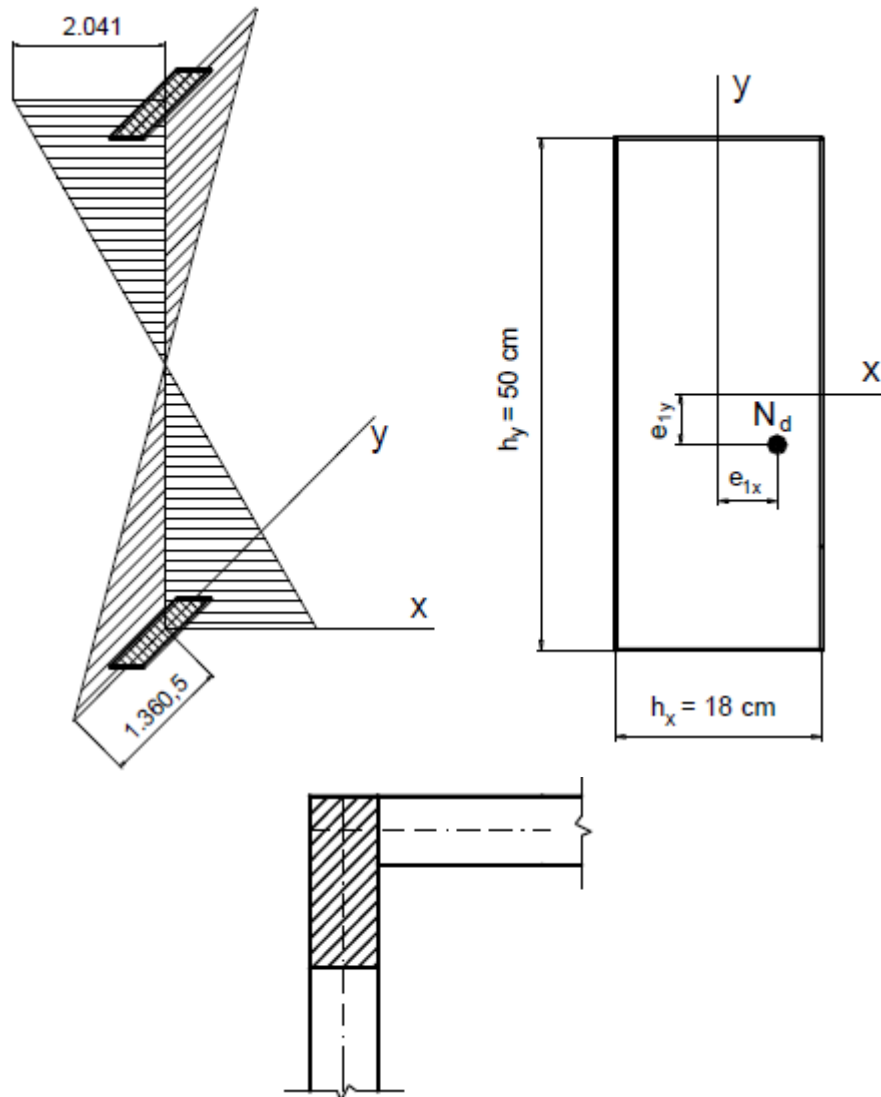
Arranjo estrutural do pilar na planta de fôrma, dimensões da seção transversal e posição do ponto de aplicação da força normal N_d , e momentos fletores solicitantes de 1ª ordem.
